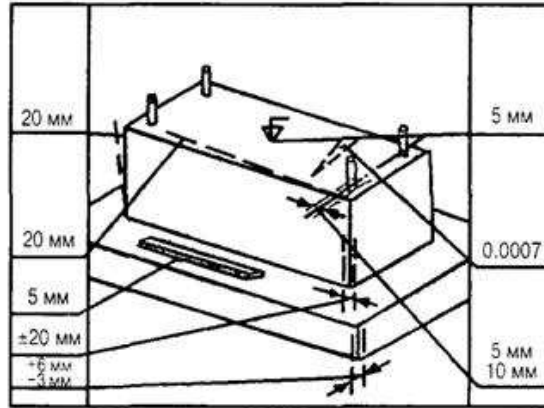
Допустимі відхилення при влаштуванні монолітних бетонних і залізобетонних фундаментів
